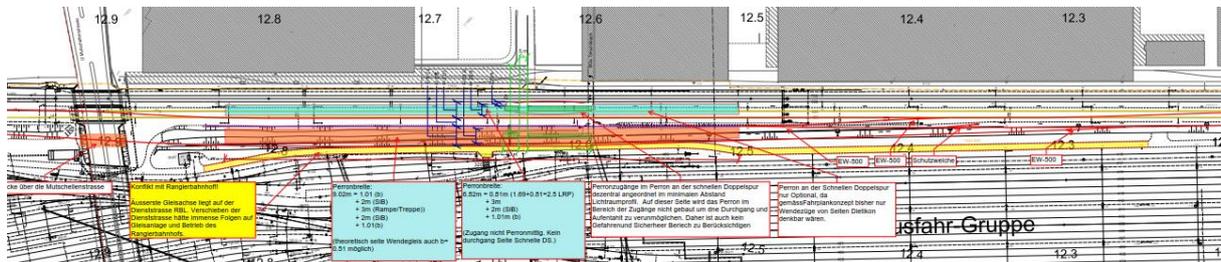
Ausschnitt Anlagelayout Variante 10.3
